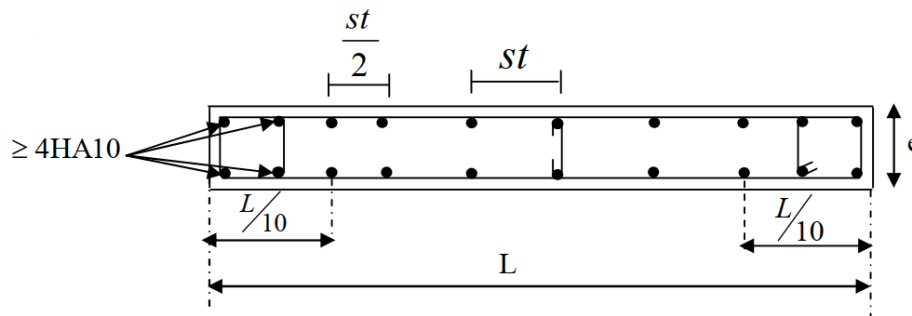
Disposition des armatures verticales dans les voiles.
